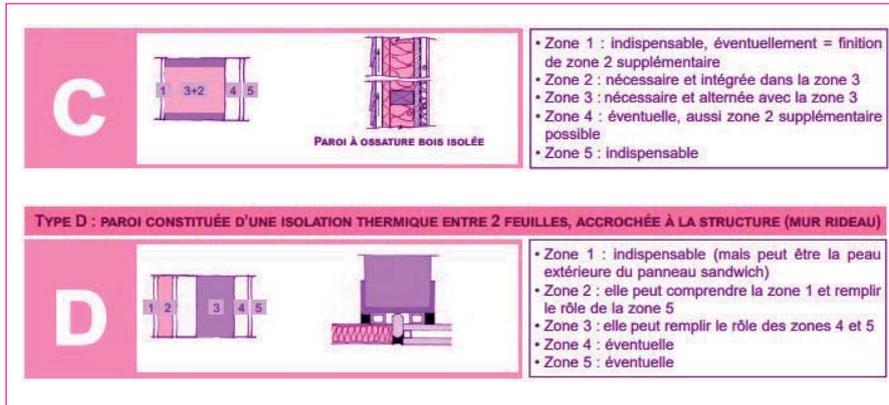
Typologies de parois – type C : paroi multicouche avec une zone d'isolation thermique intégrée à la structure traversante ; type D : paroi constituée d'une isolation thermique entre deux feuilles, accrochée à la structure (mur rideau)
